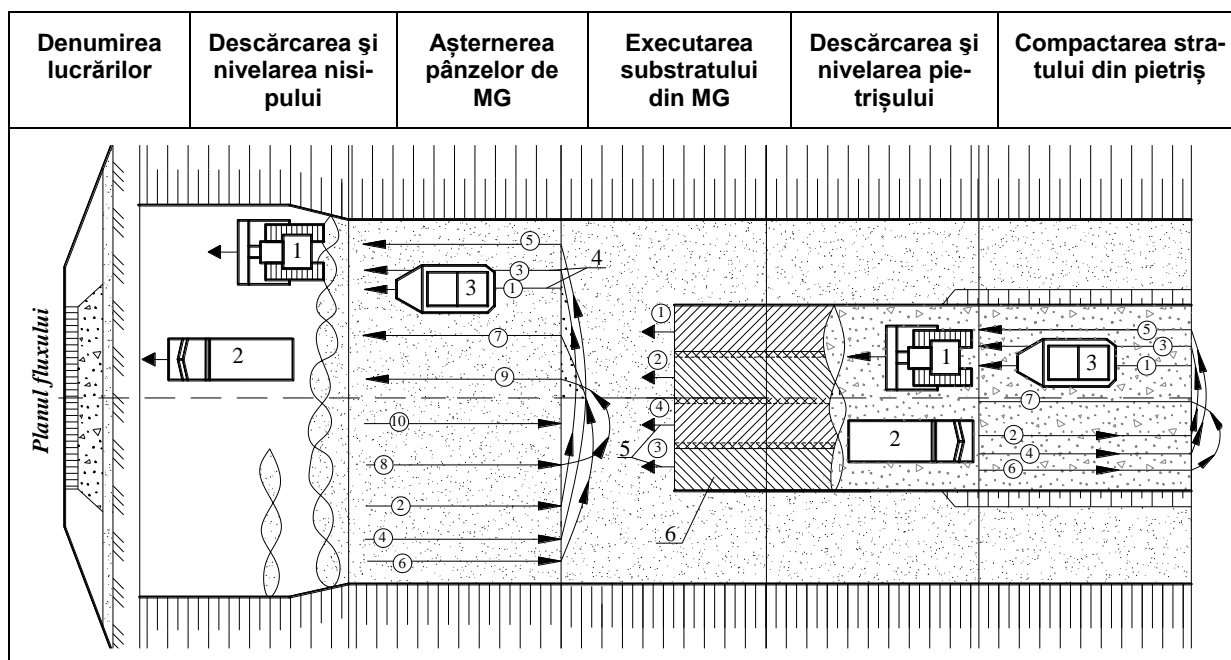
Schema tehnologică de executare a substraturilor cu rol de protecție și armare din MG sub fundația structurii rutiere
